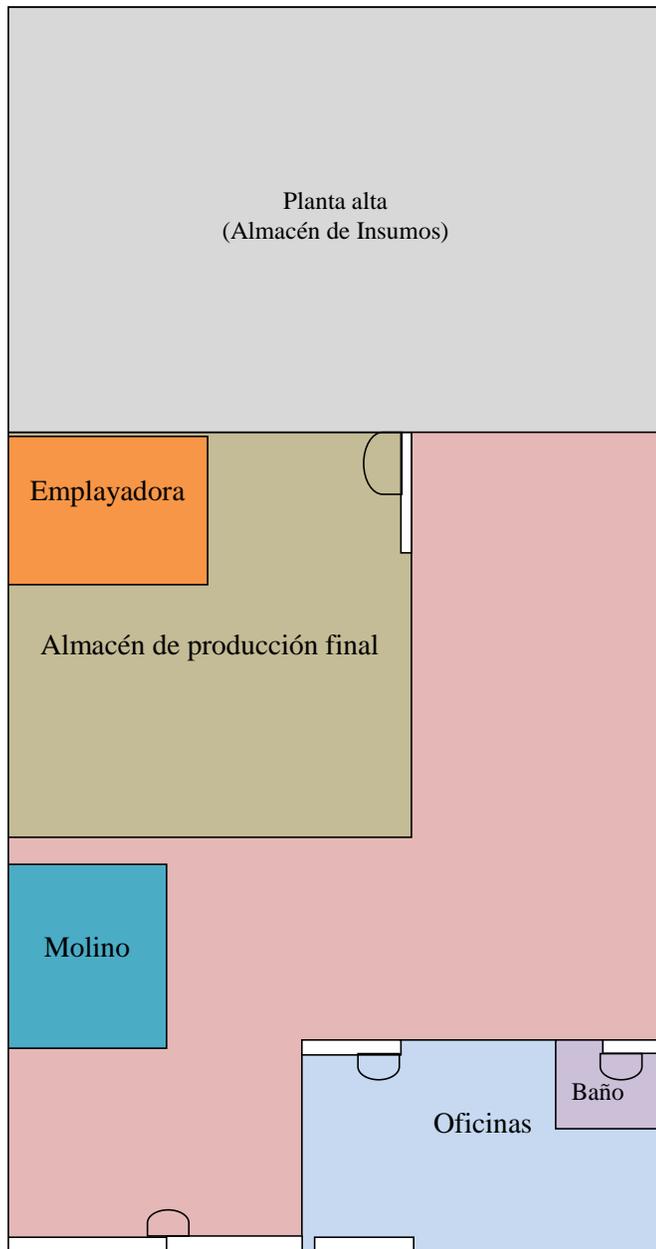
Distribución de Planta Actual de la empresa PLANTA BAJA
